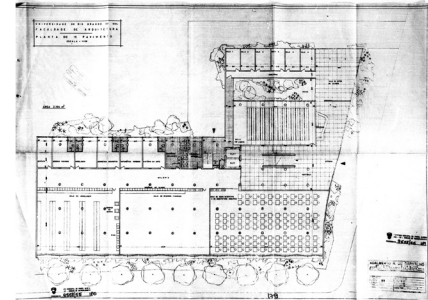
Faculdade de Arquitetura, UFRGS. Planta, Pavimento Térreo, DASP, 1954/1957.
